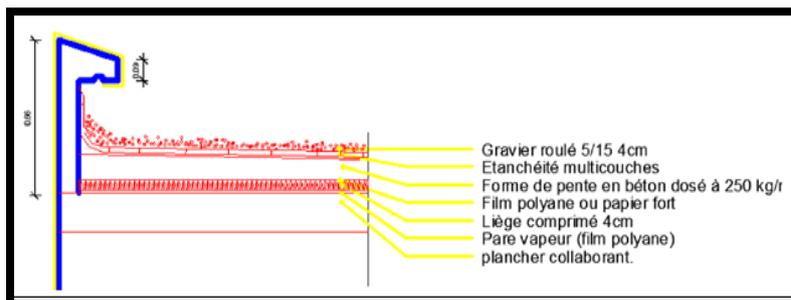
coupe schématique du plancher terrasse Source : <http://fr.silvadec.com>
